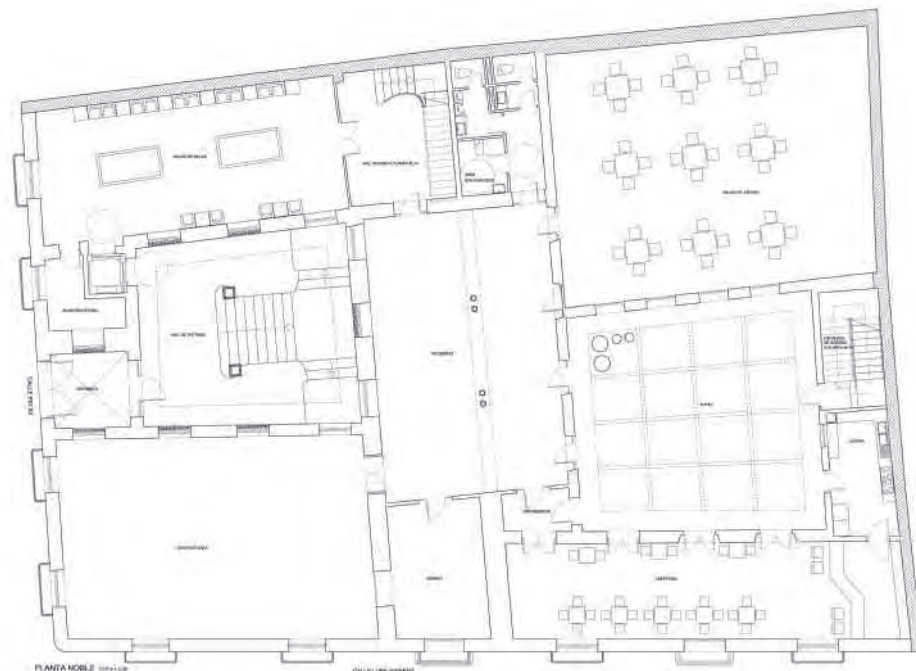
Planta noble con las dependencias más características de la edificación, tras la restauración proyectada.
